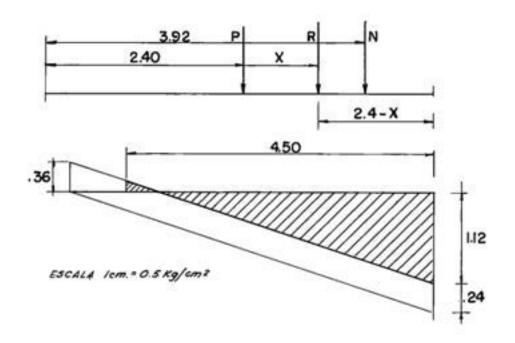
FIGURA - II CARGAS SOBRE LA ZAPATA SISMO LONGITUDINAL
